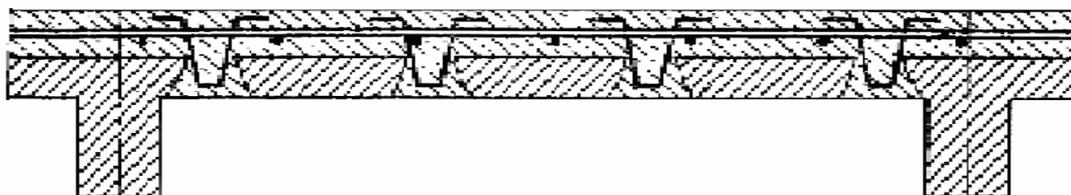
Усиление сжатой зоны плиты наращиванием
